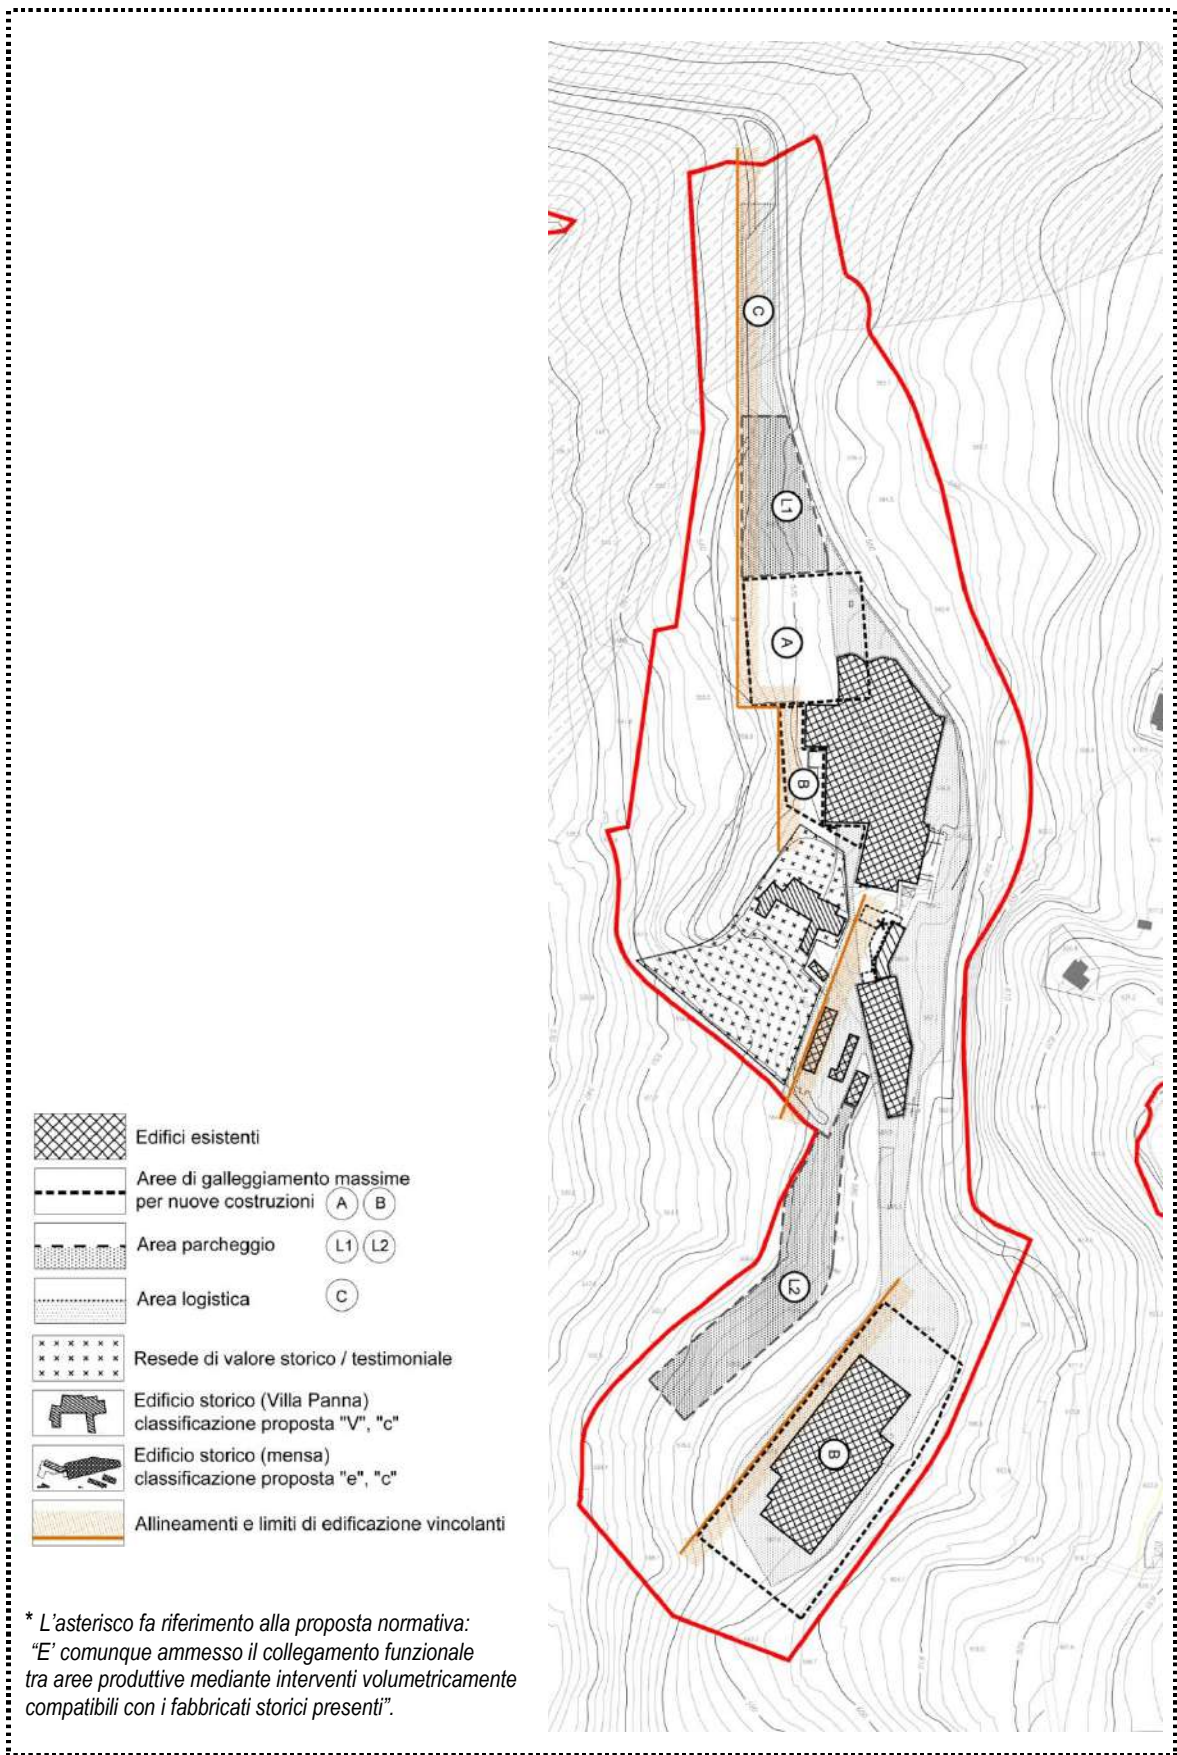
Schema planimetrico Alternativa A "lineare" (2019)
